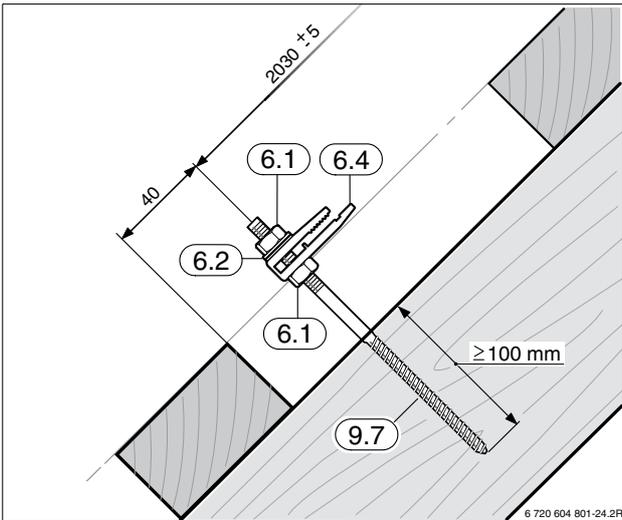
Stockschraube (Mindesteinschraubtiefe 100 mm) und Klemmstück Oberkante Lattung montieren
